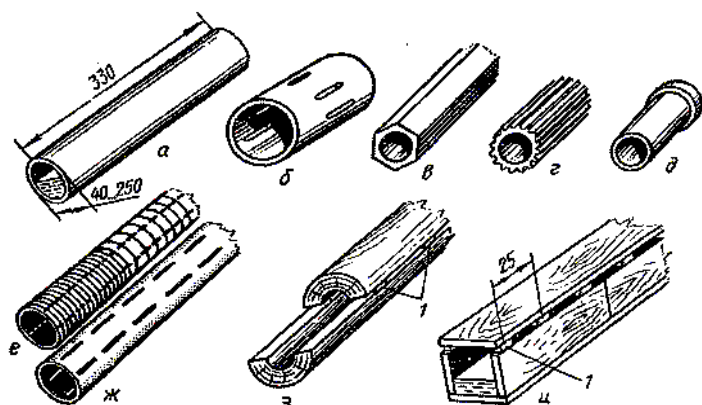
Конструкция дренажных труб: гончарные: а – круглая; б – щелеванная; в – шестигранная; г – рифленая; д – раструбная. Пластмассовые: е – гофрированная; ж – гладкостенная. Деревянные: з – желобковая; и – дощатая; 1 – прокладки
